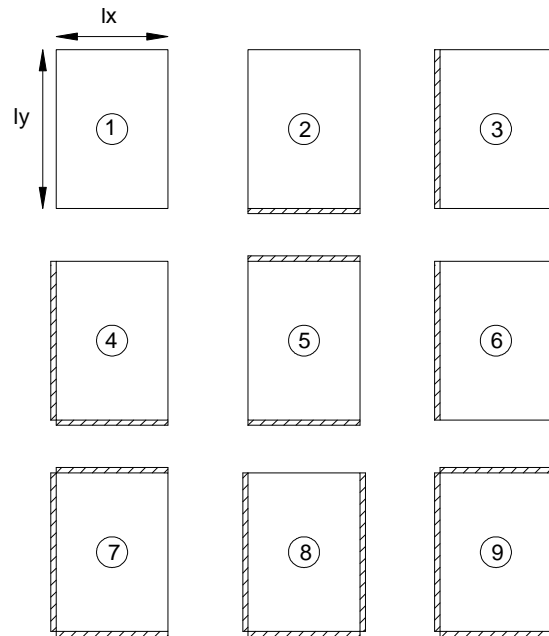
Condições de apoio para lajes armadas em duas direções.
